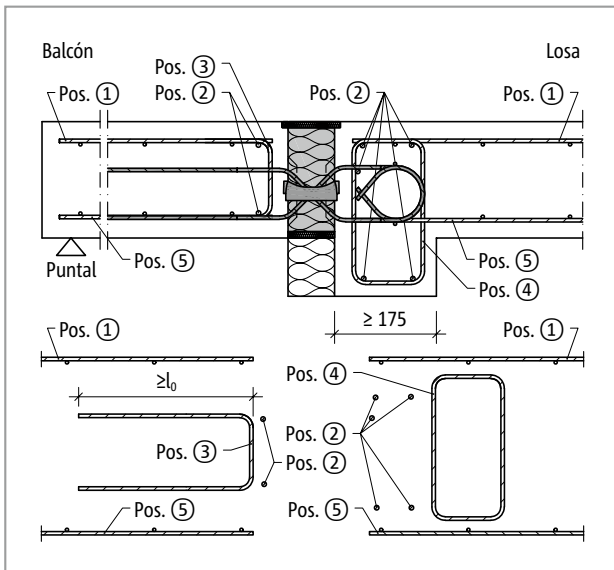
Schöck Isokorb® T tipo Q-VV1 hasta Q-VV5: Armadura in situ en la viga de cuelque
